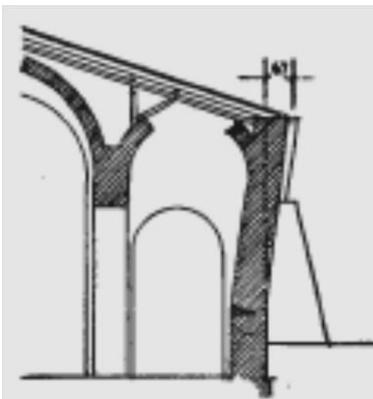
Aparición de grietas horizontales profundas en las dos caras del muro sur.
